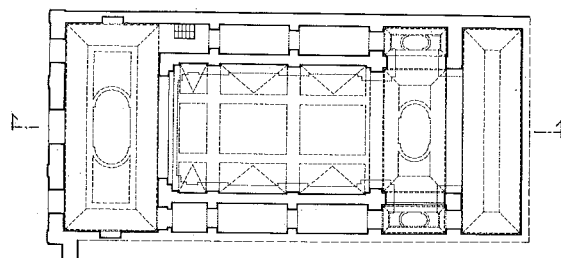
Pianta con la proiezione delle volte di copertura.
